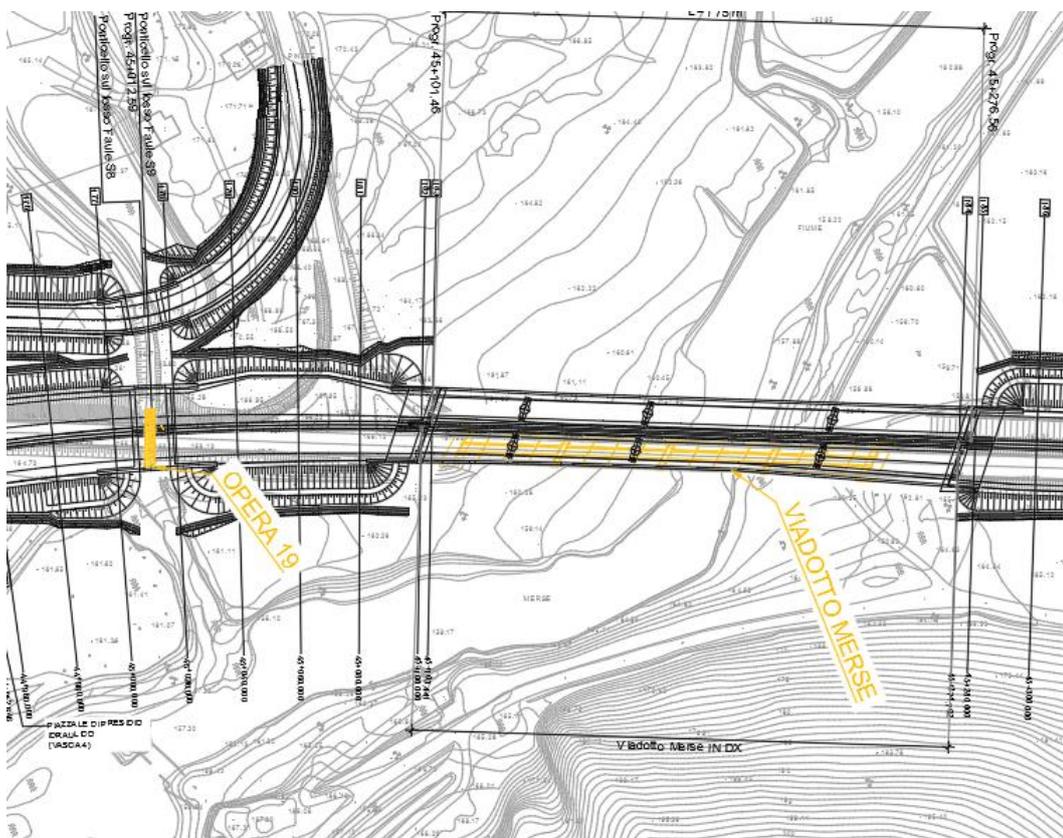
Posizione del viadotto esistente nella planimetria di progetto
